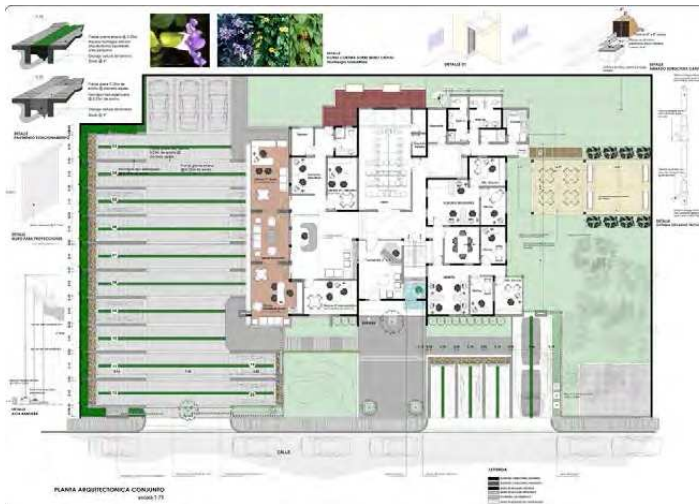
Planta Arquitectónica Oficinas Grupo Banas
